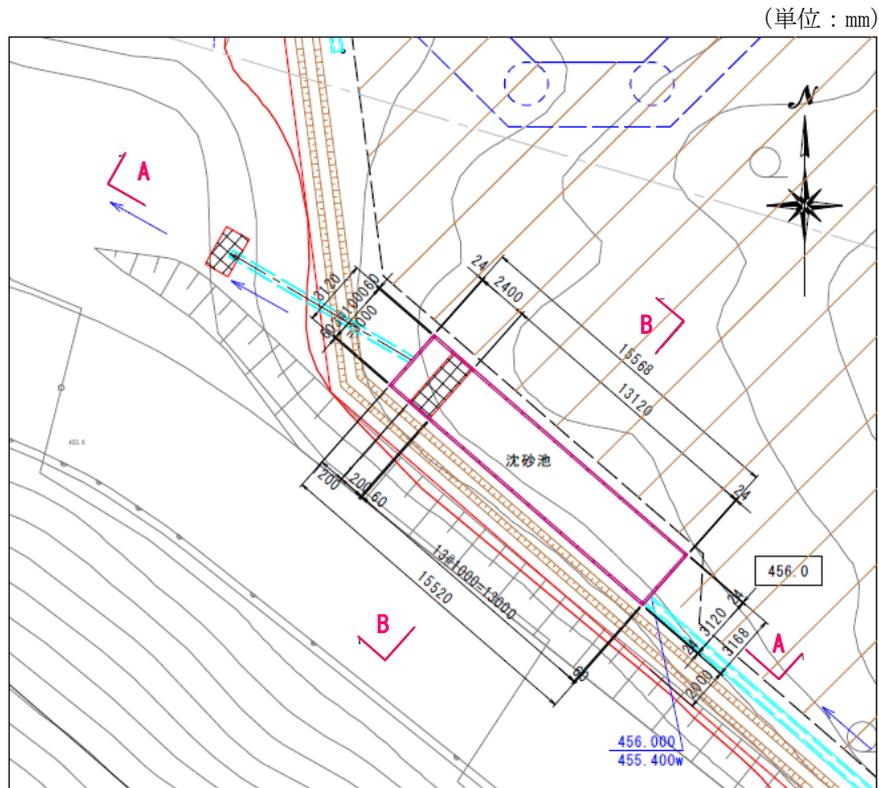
(1) 濁水対策設備（沈砂池）の標準構造図（沈砂池平面図）
